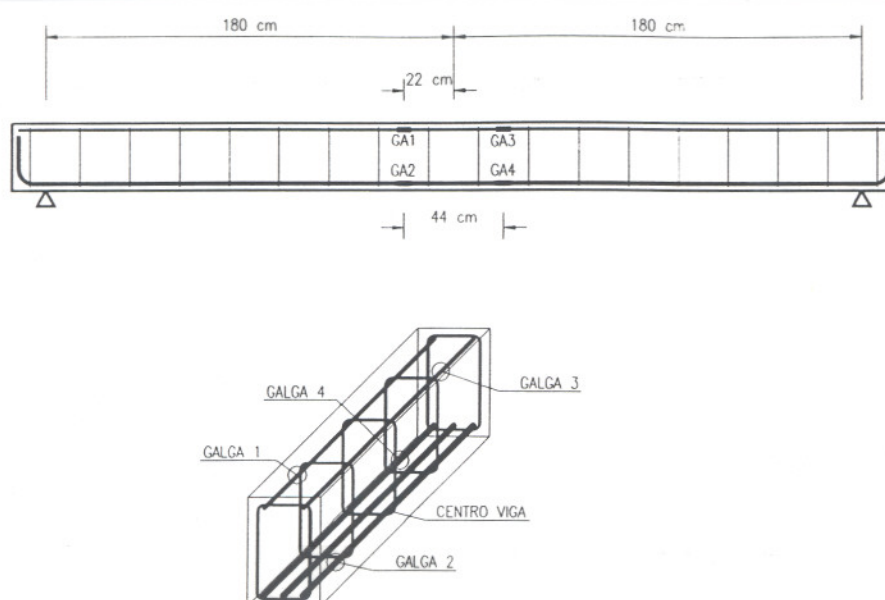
Esquema de la instrumentación de la armadura longitudinal
